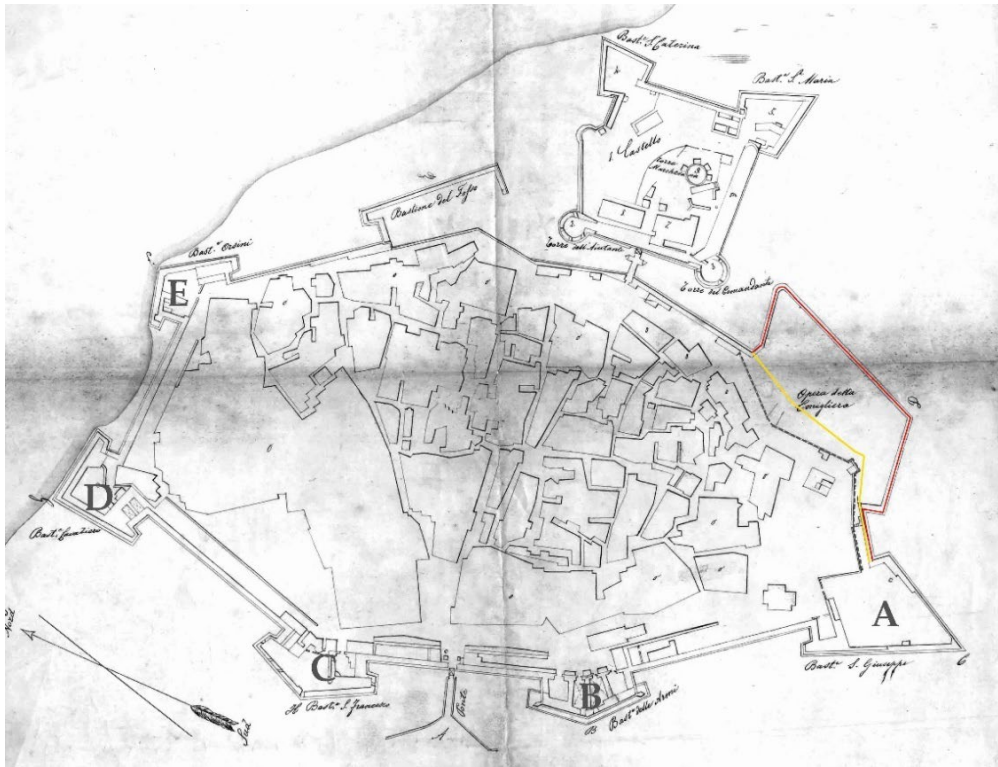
Pianta della piazza e castello di Crotone (ISCAG, FO 105/8118 B. Rielaborazione T. Tedesco).
